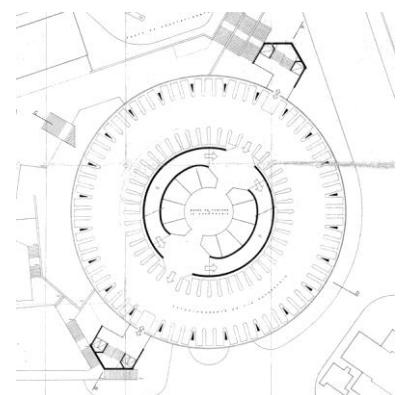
Vista norte do Silo Auto, Porto, 1964 (Planta)
